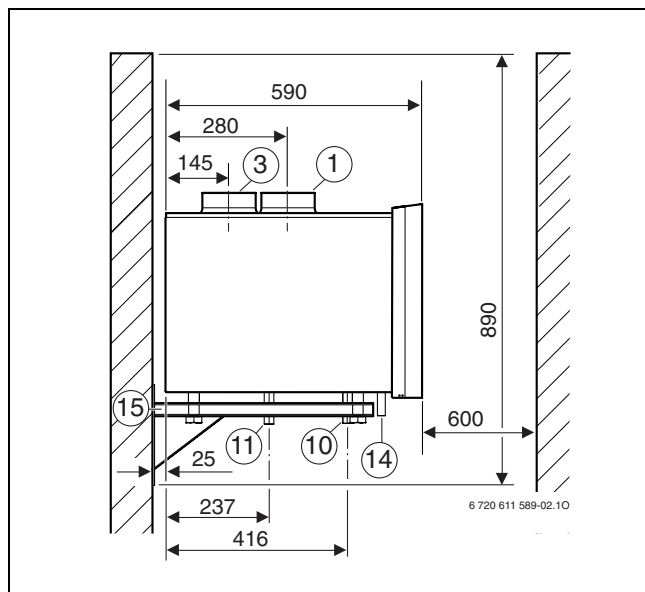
Bau- und Anschlussmaße (Maße in mm)
